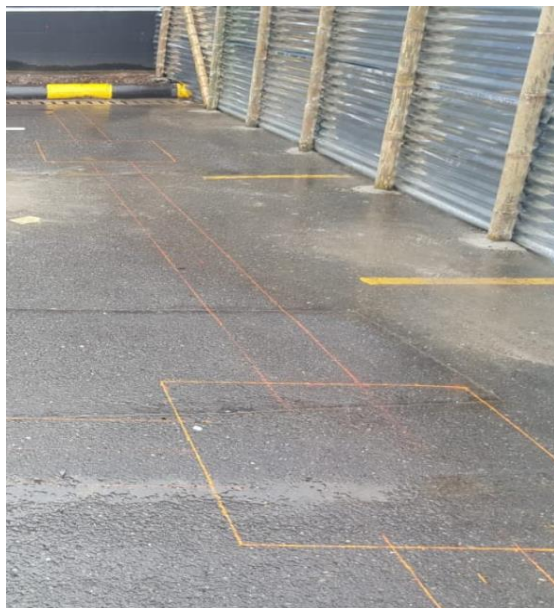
(Rojas C, 2018) Localización y replanteo en pavimento. Foto tomada en sitio
